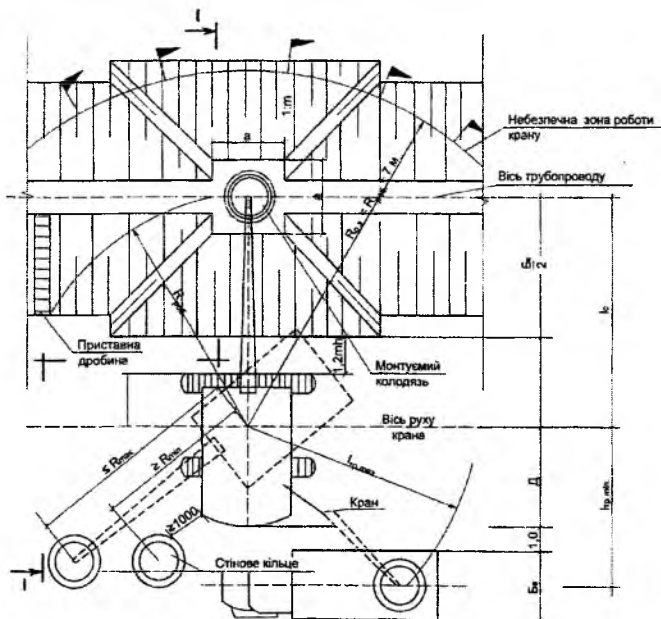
Схема монтажу колодязя з попереднім розкладанням елементів
